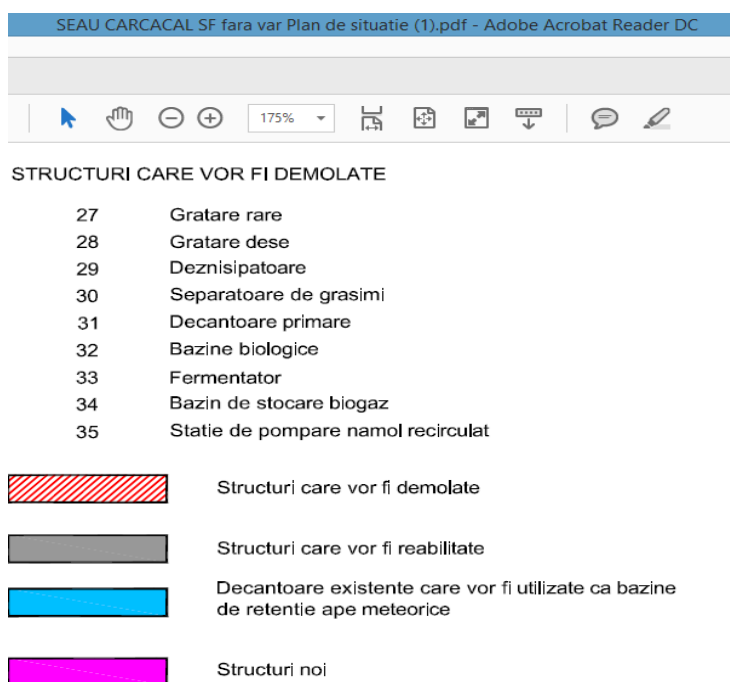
Extras Plan de situatie SEAU Caracal – SF
